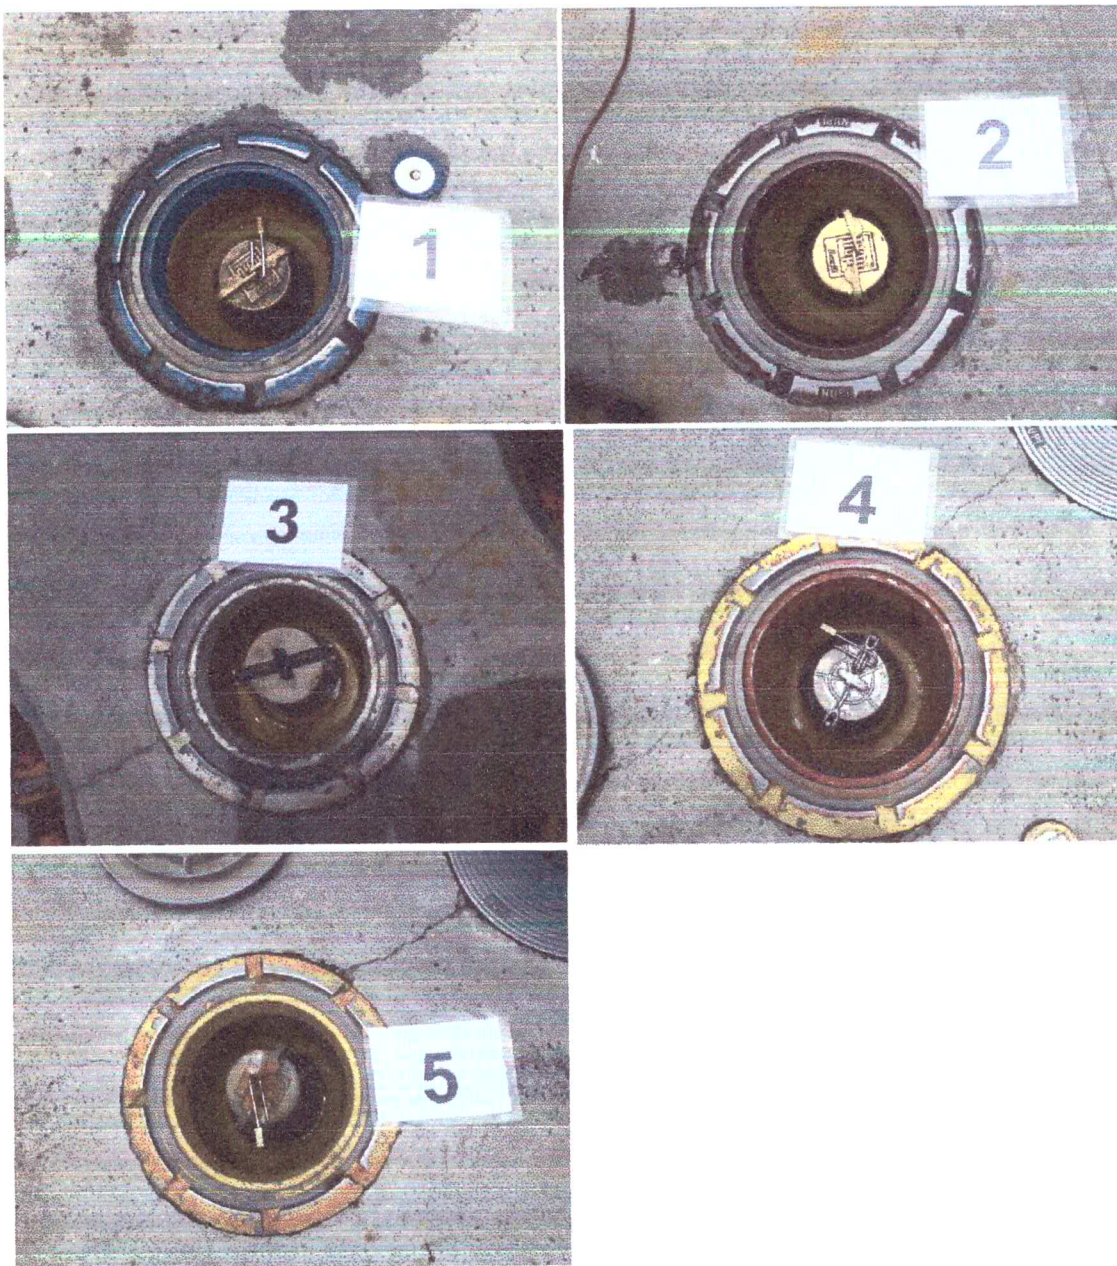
Câmaras de contenção (sump) – Filtro Prensa 01
